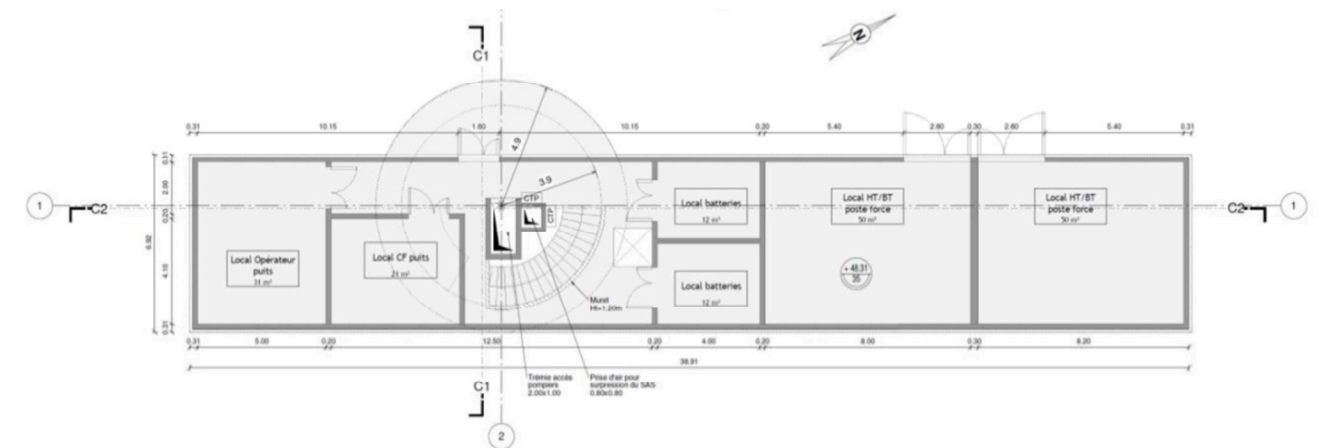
Vue en plan du niveau N1 de l'OA 3407P
